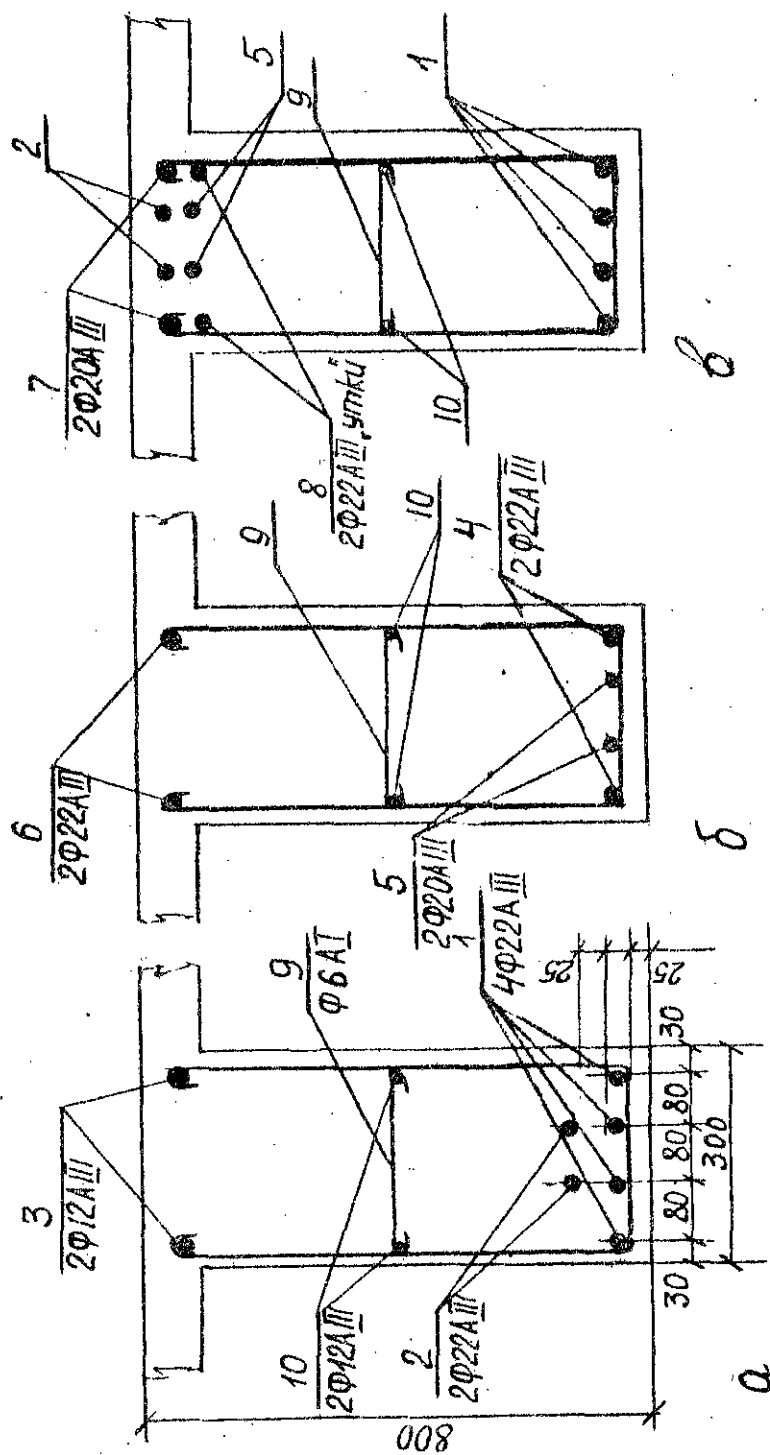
Армирование сечений балки: а - в крайних пролетах; б - в среднем пролете; в - на опорах δ и ϵ
